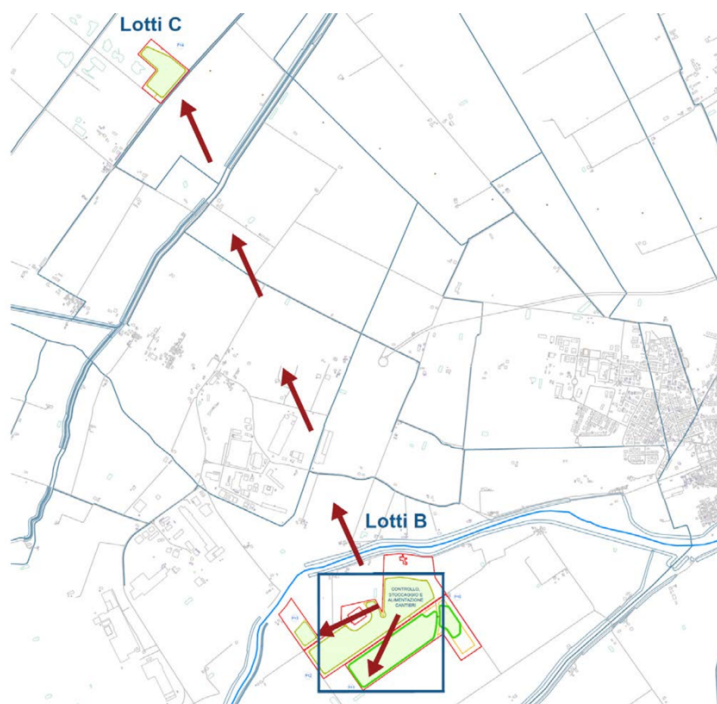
Schema generale di cantiere macro lotti B e C (fonte: ER_10_Piano_di_cantierizzazione)
